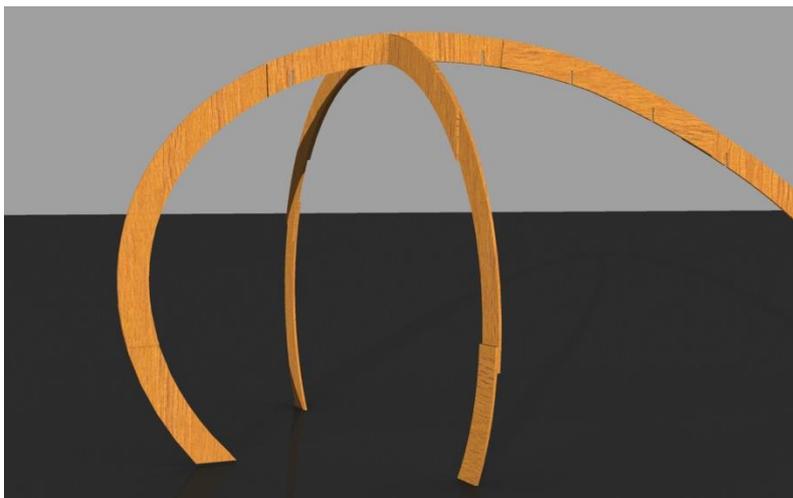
| Exemplificação da estrutura. Arco maior transversal e arco maior longitudinal.
